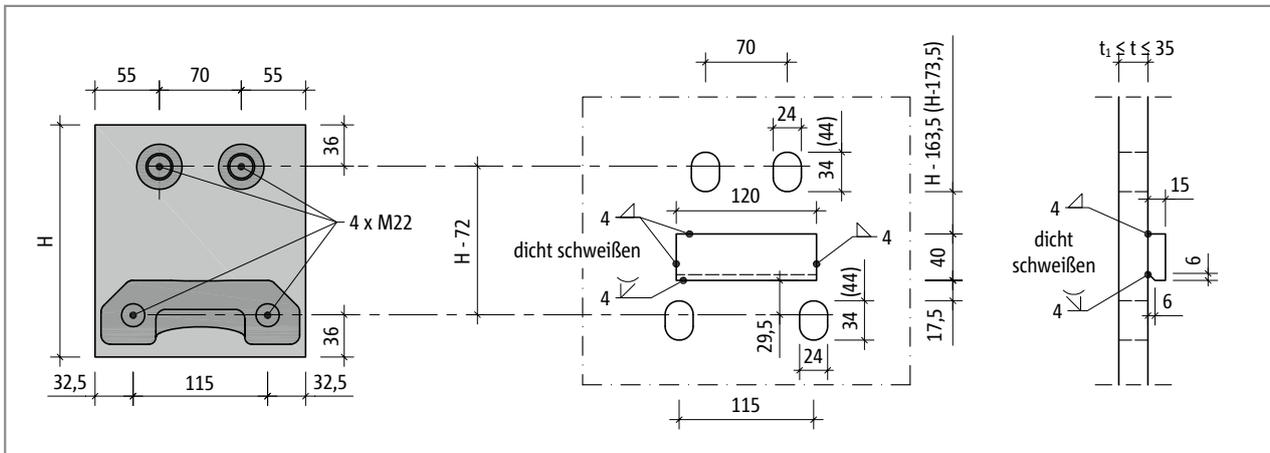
Schöck Isokorb® T Typ SK-MM2: Konstruktion des Stirnplattenanschlusses
